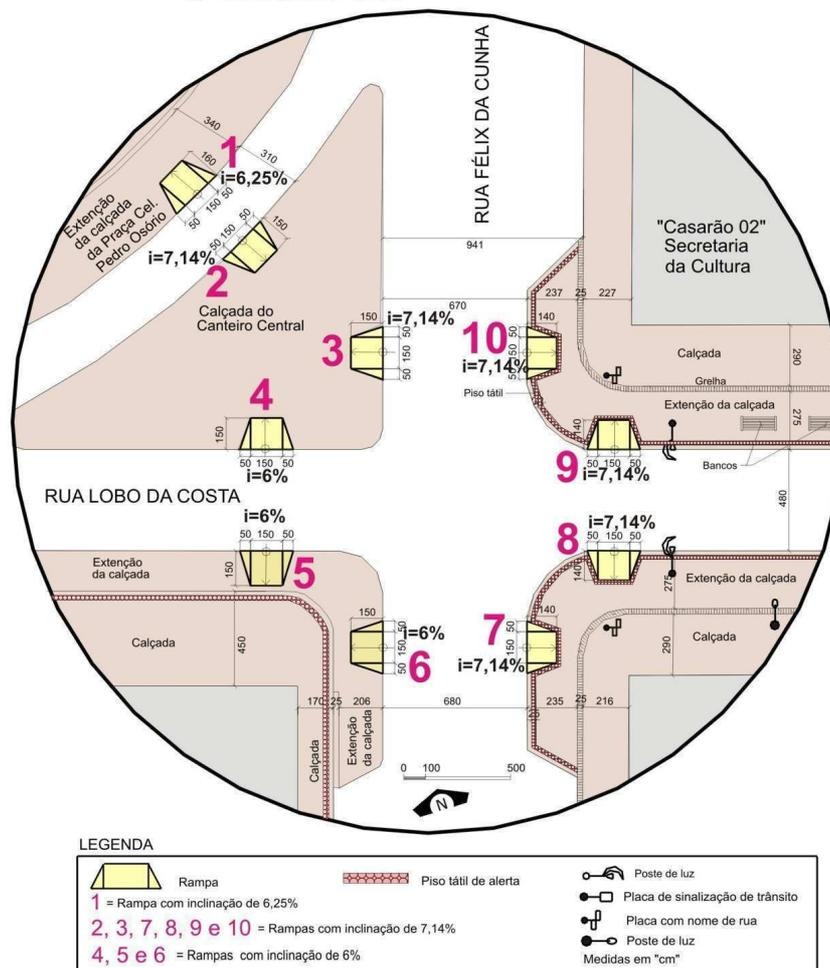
Detalhe 6 do levantamento preliminar da Figura 3.9
